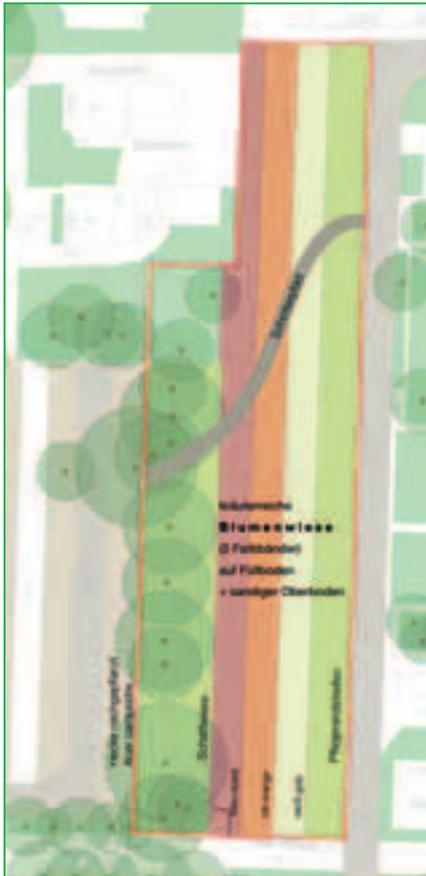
Auszug aus dem umgesetzten Entwurfsplan Heidestraße Nord, Plan: Station C 23.
